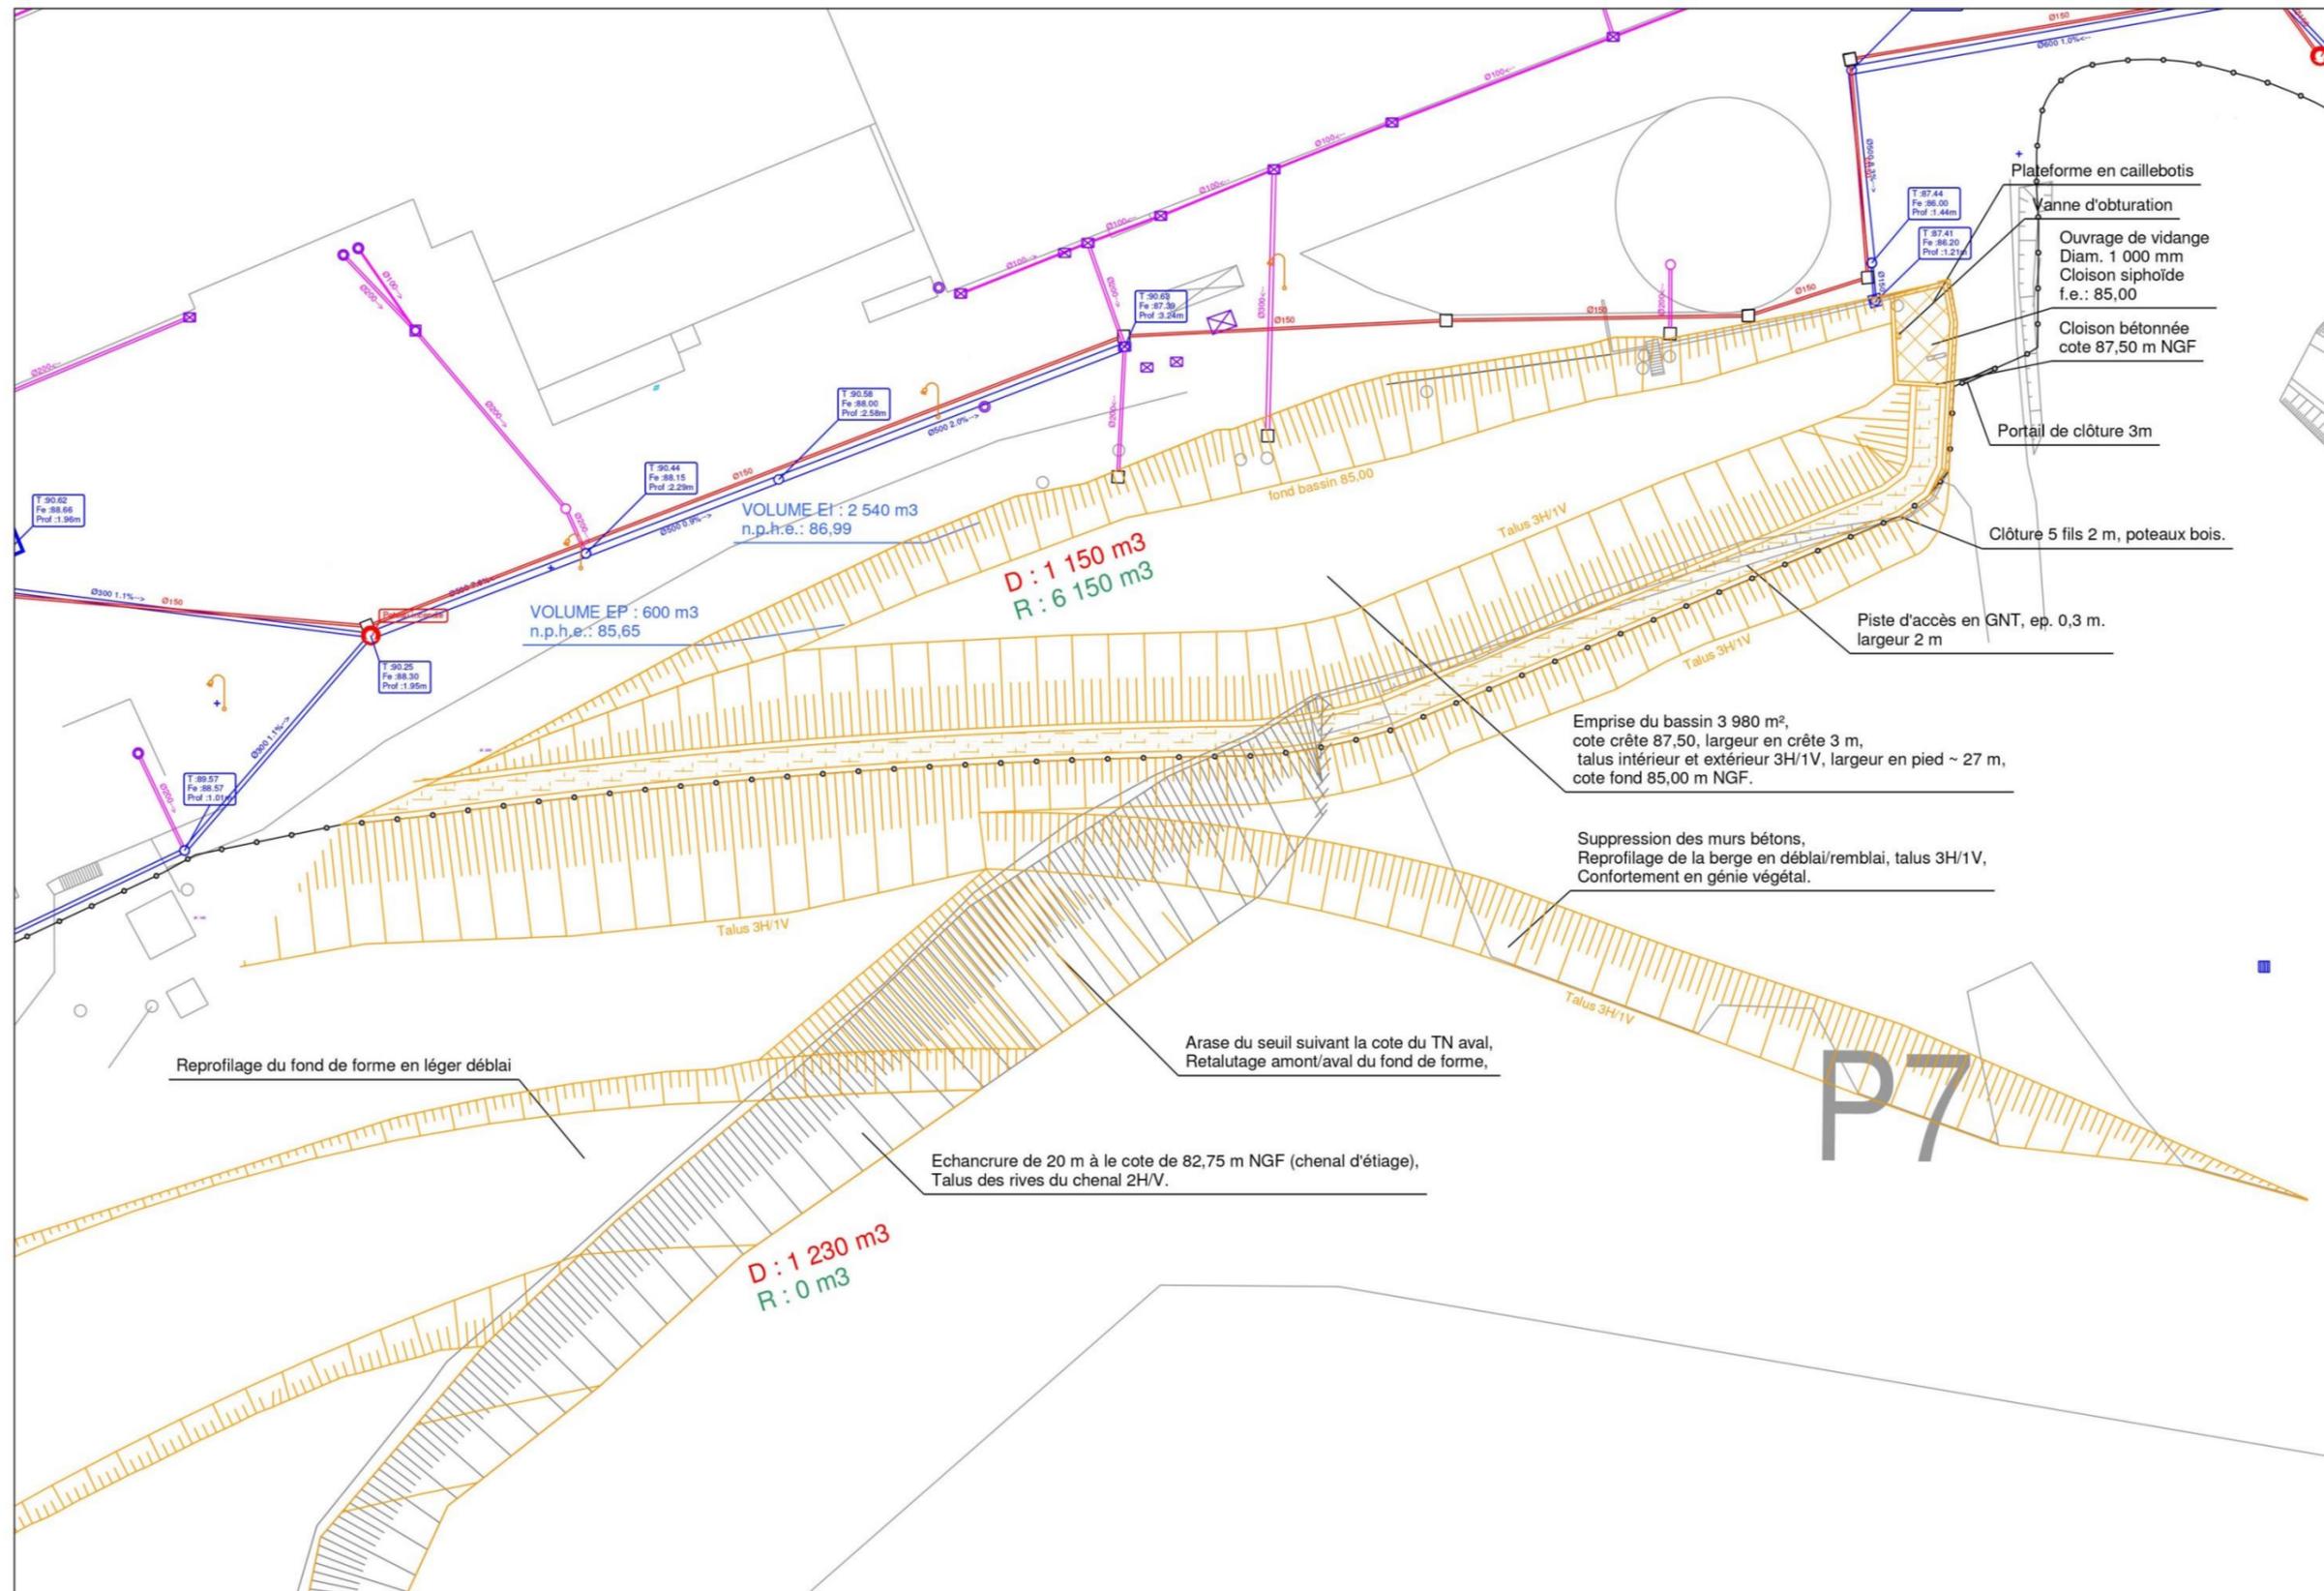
Vue en plan du bassin Sud - Bief amont du barrage
